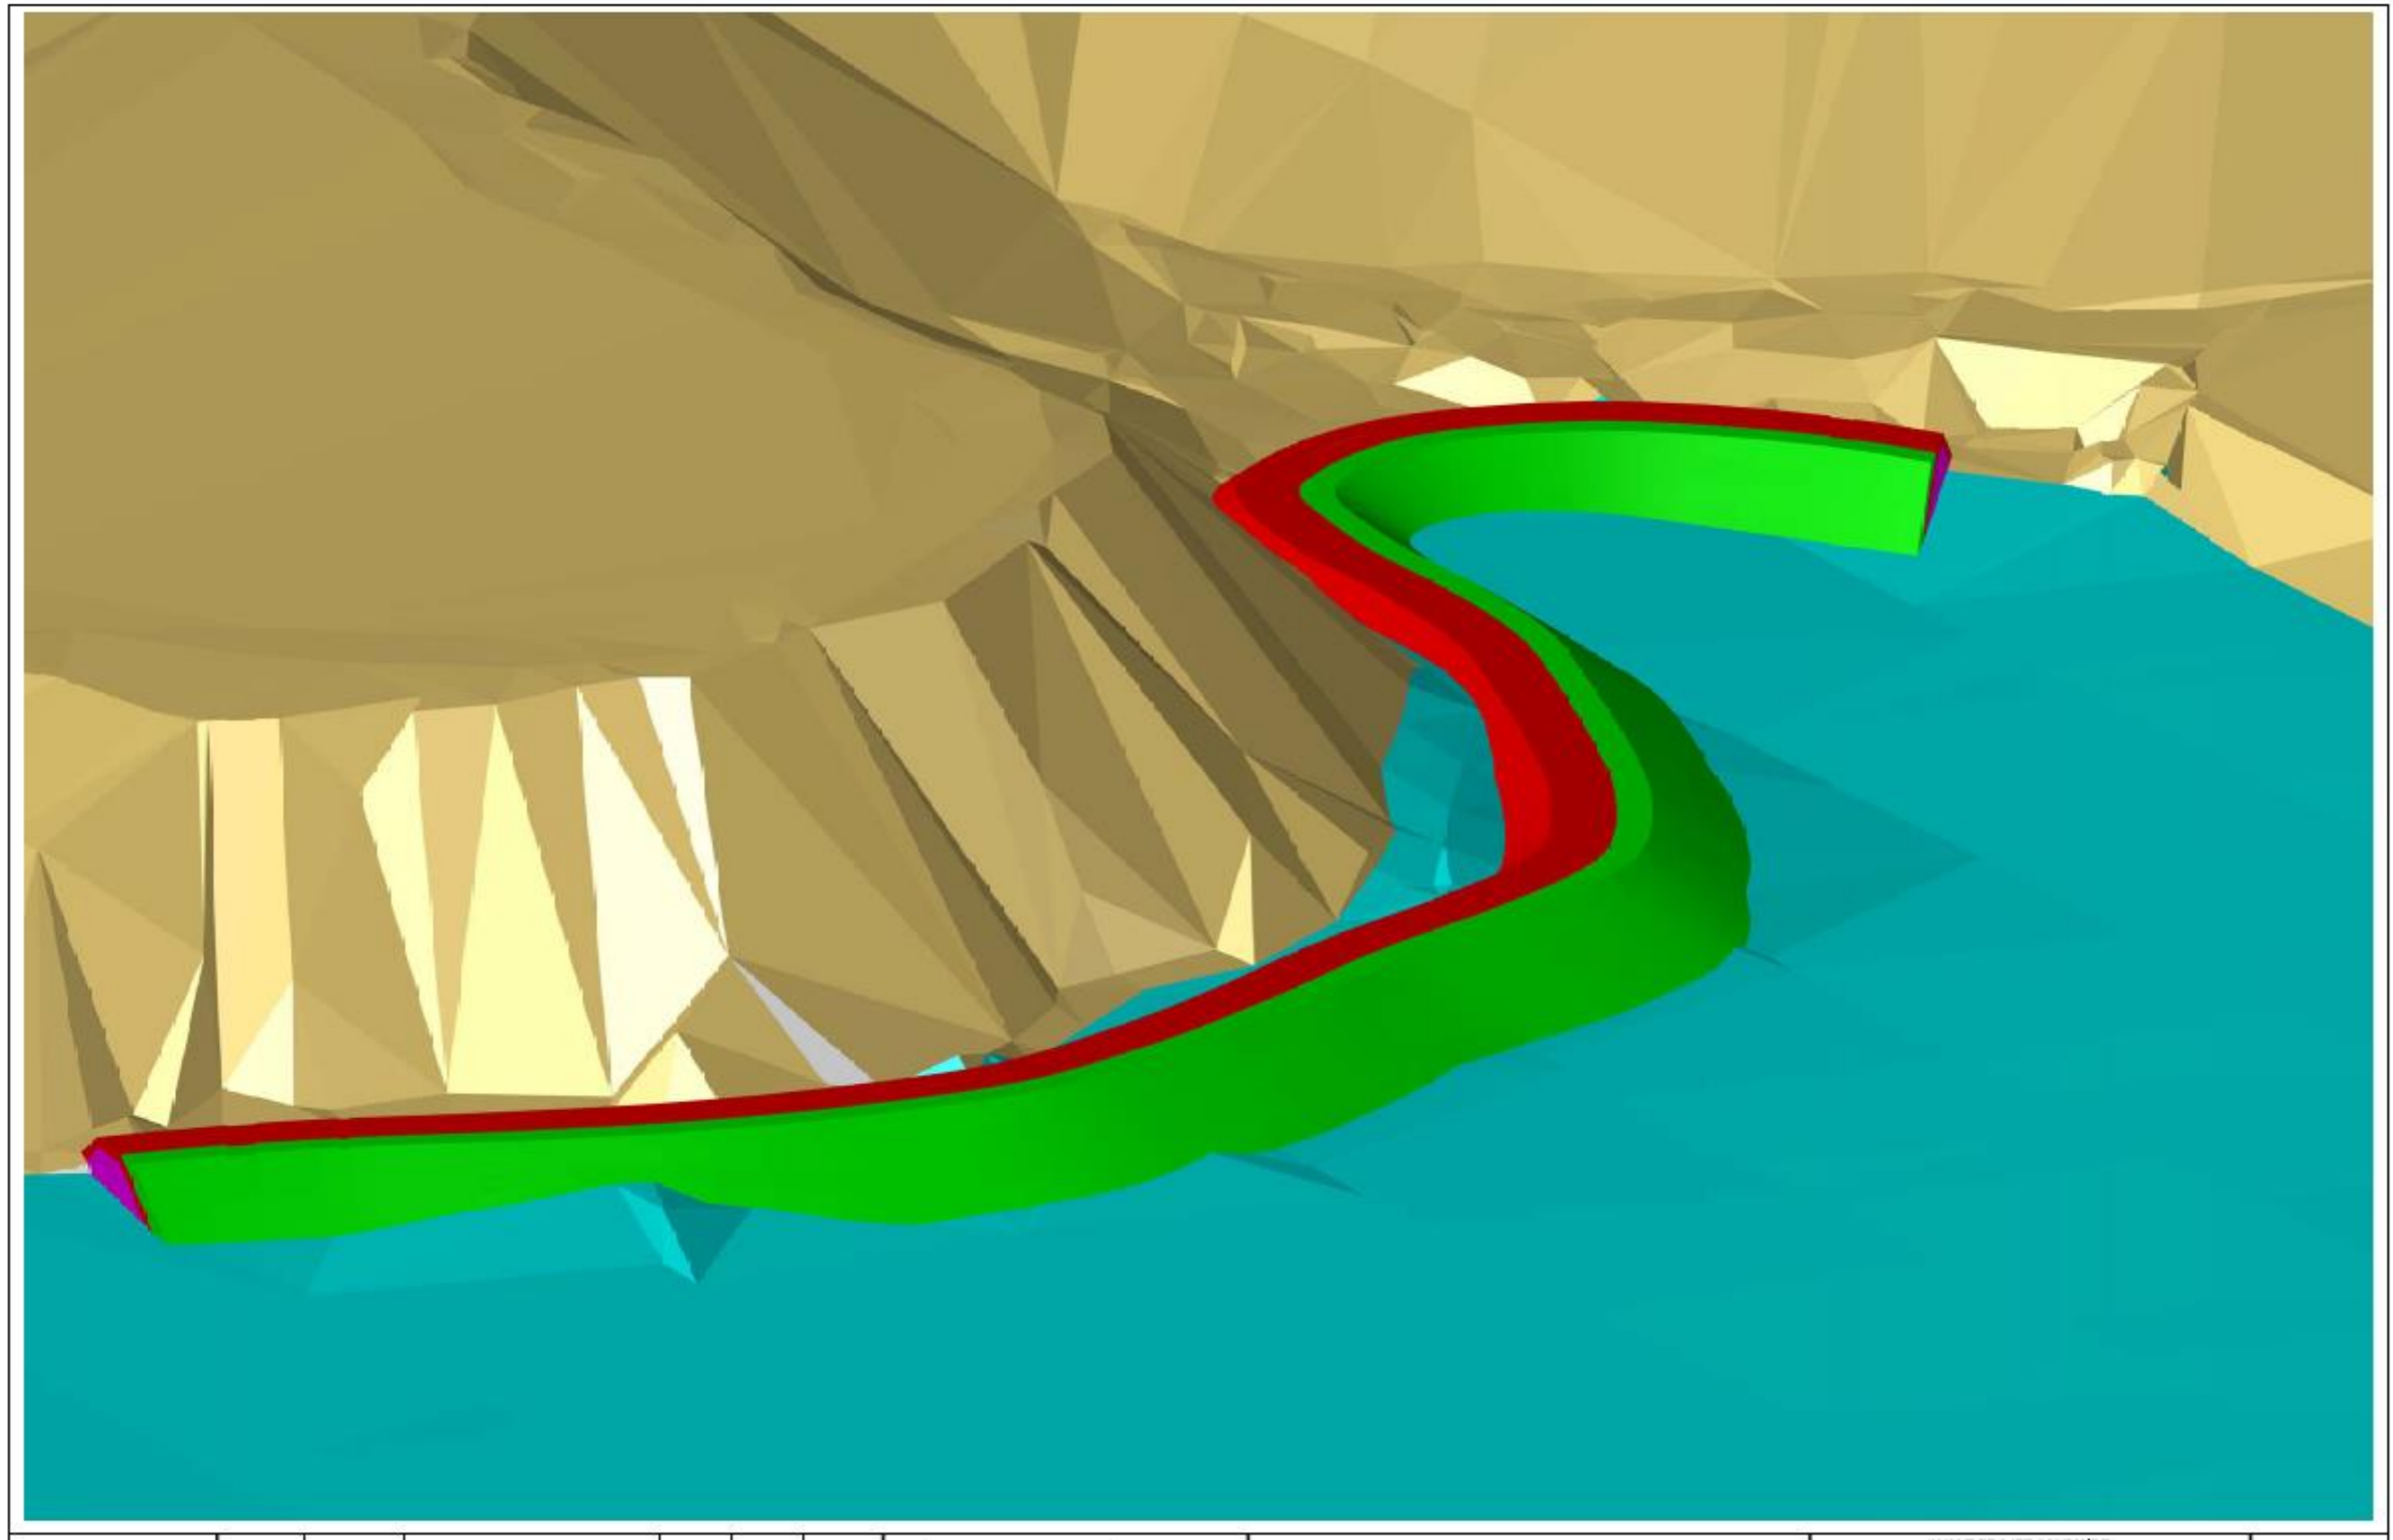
Plan de Masse des digues en enrochements prévues au droit de la falaise et de la plage de Anse Bernard
